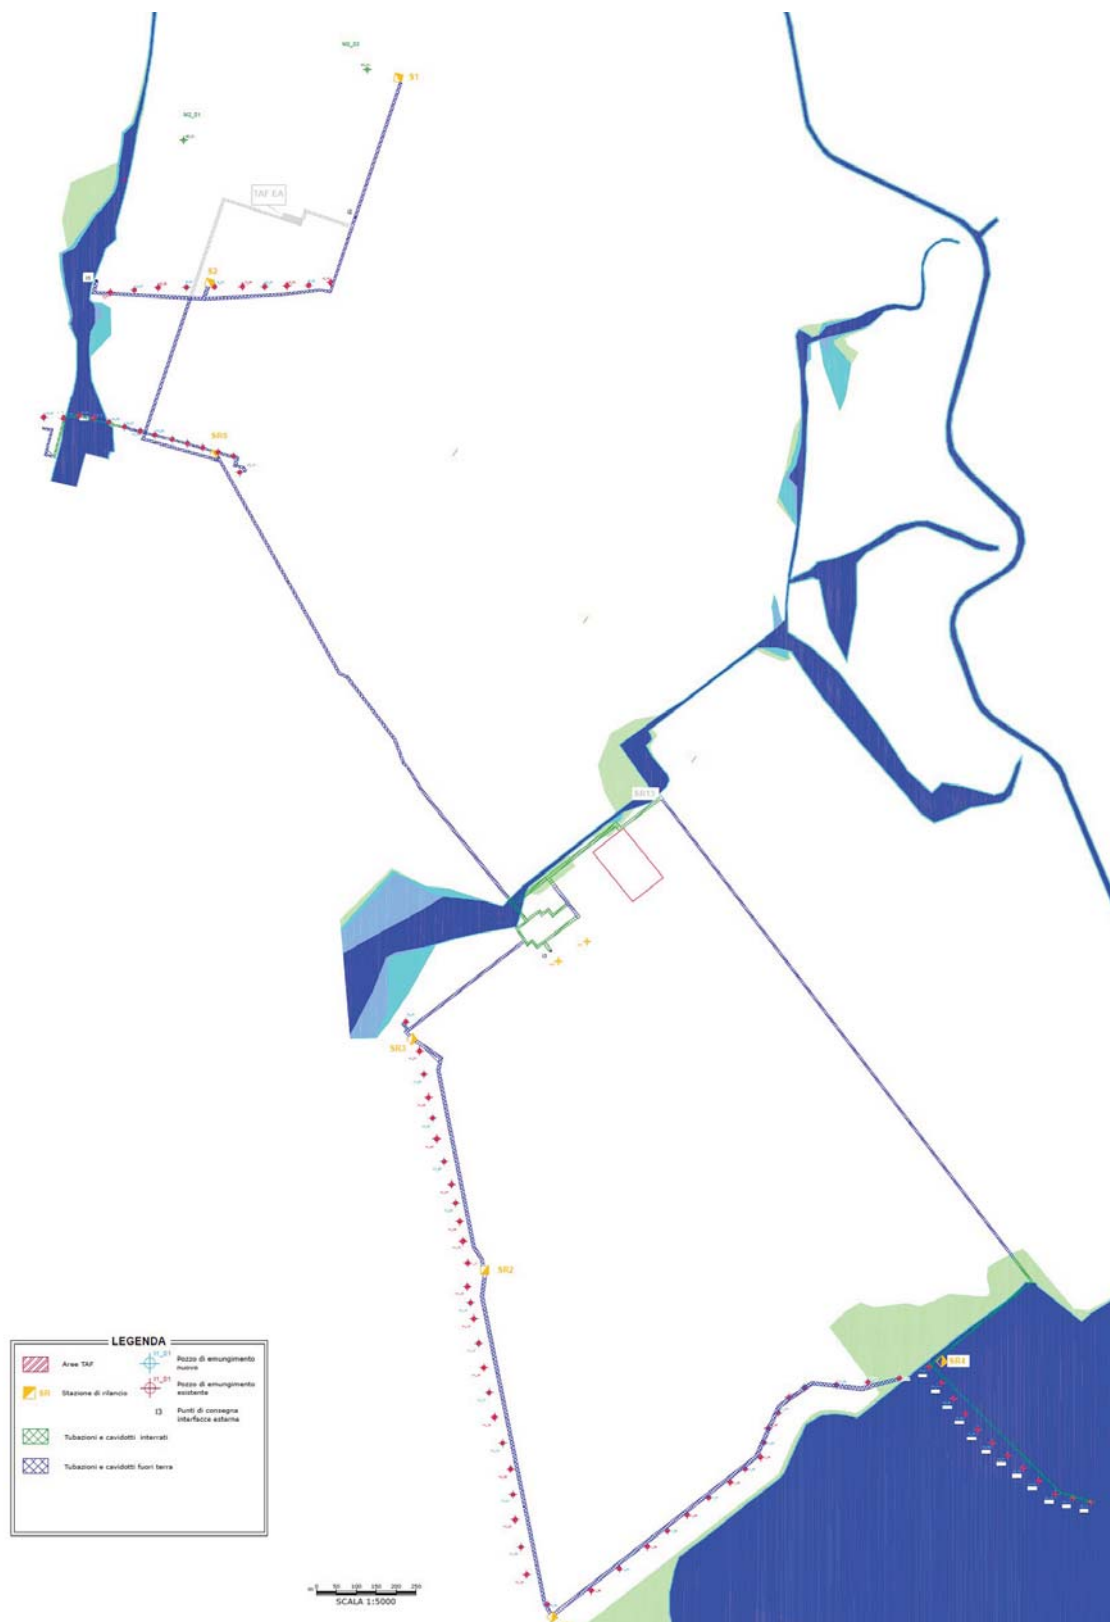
Planimetria con l'indicazione delle opere previste e la pericolosità idraulica vigente
